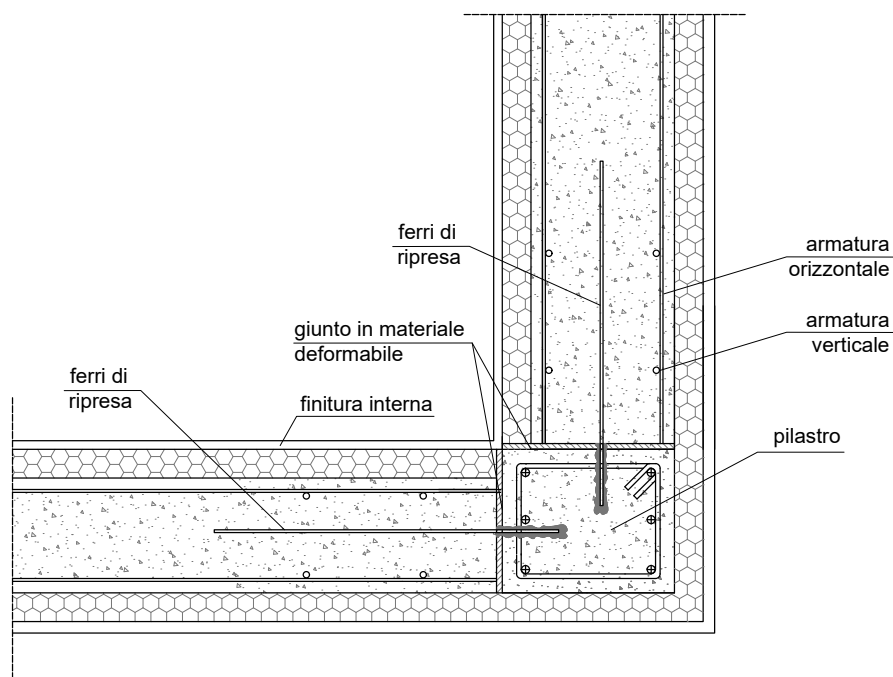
Pianta di un angolo in cui due pareti di tamponamento realizzate in ICF si collegano a un pilastro.
